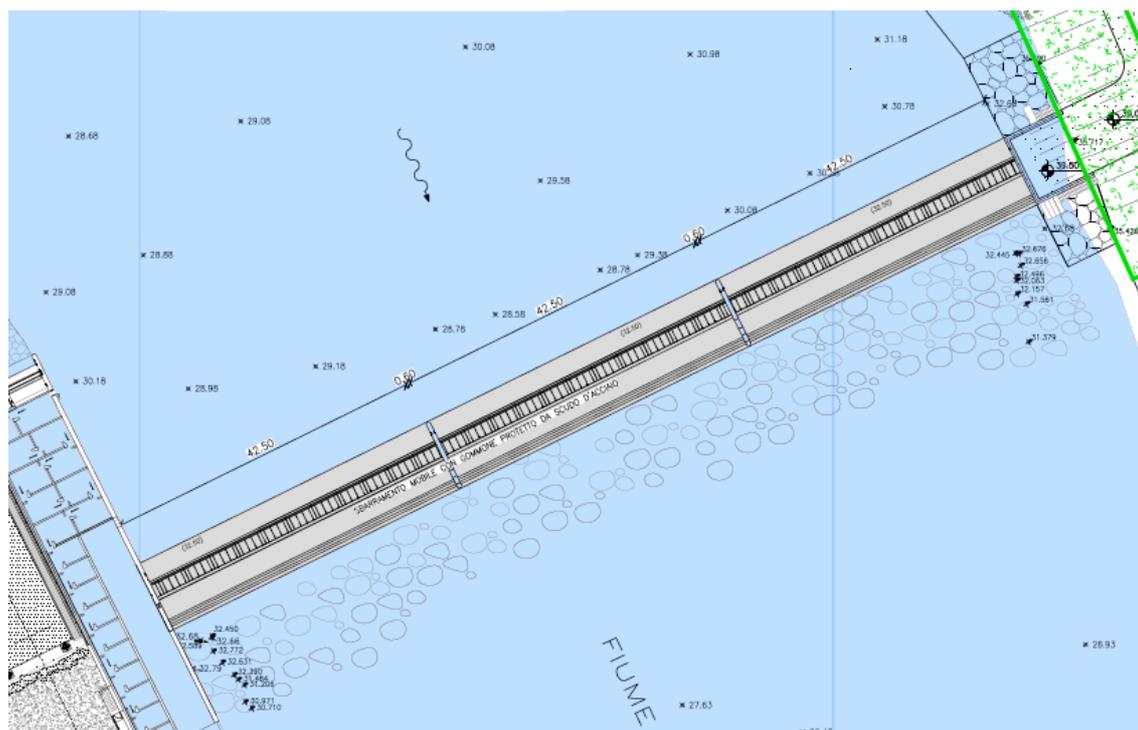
Planimetria di progetto con lo sbarramento sul fiume Adda in evidenza
